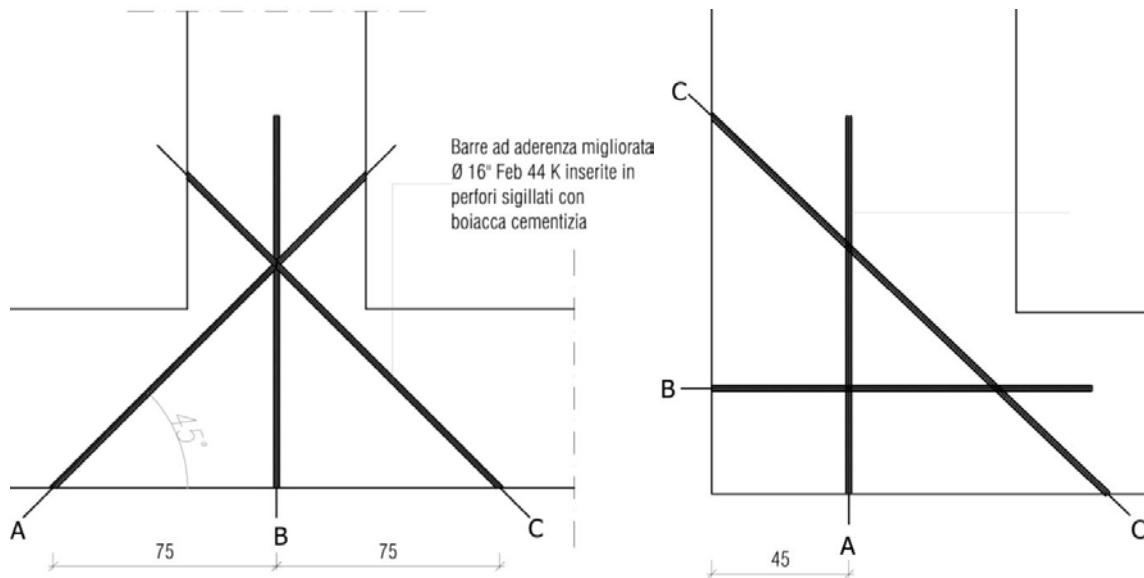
Dettagli in pianta delle chiodature armate dei cantonali
